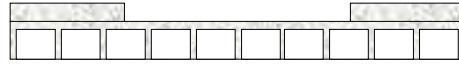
Puente con losa reticular con nervaduras longitudinales y transversales
